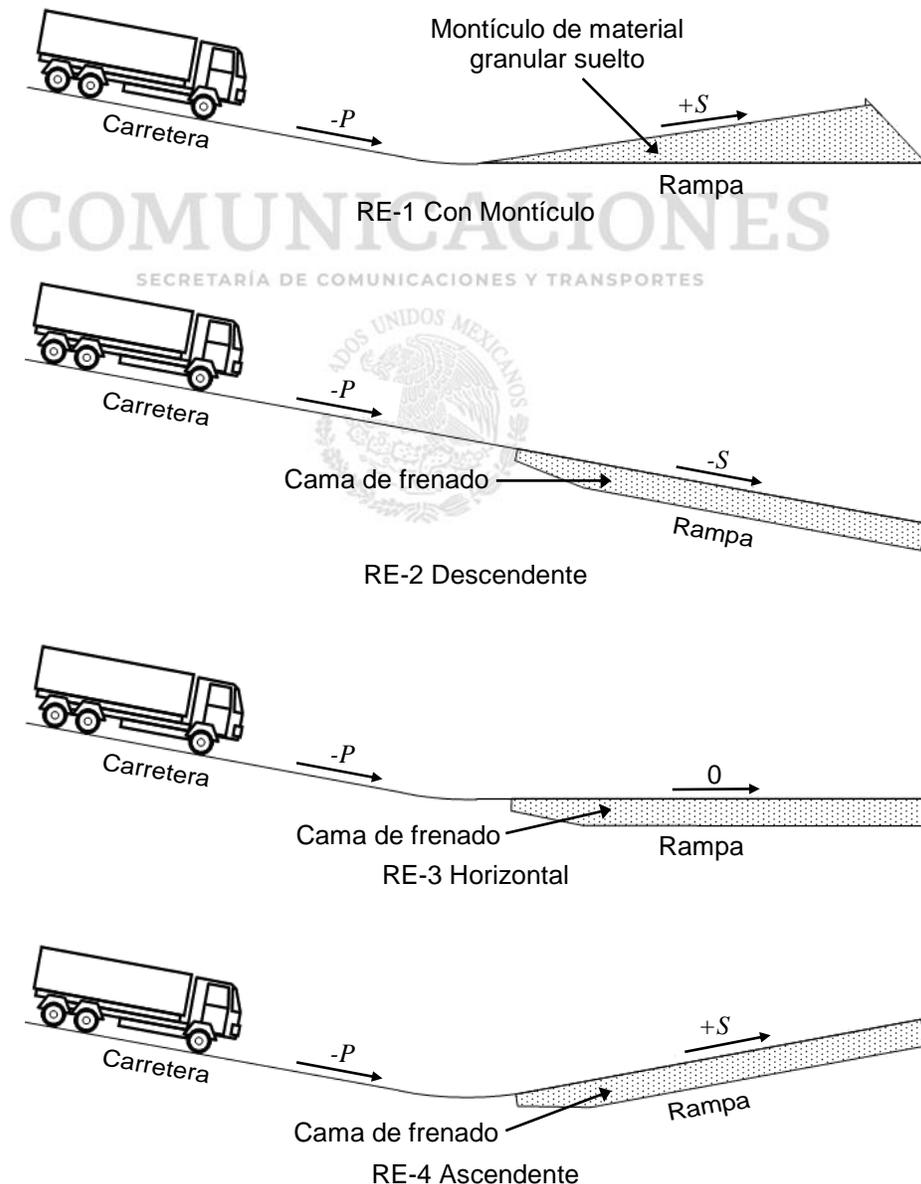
Tipos de rampas de emergencia para frenado (RE)
